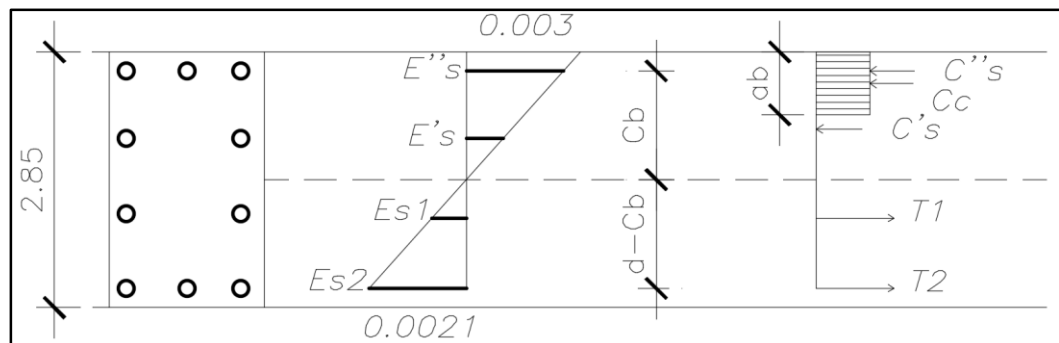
Sección rectangular. Deformaciones y fuerzas internas en el elemento estructural.
